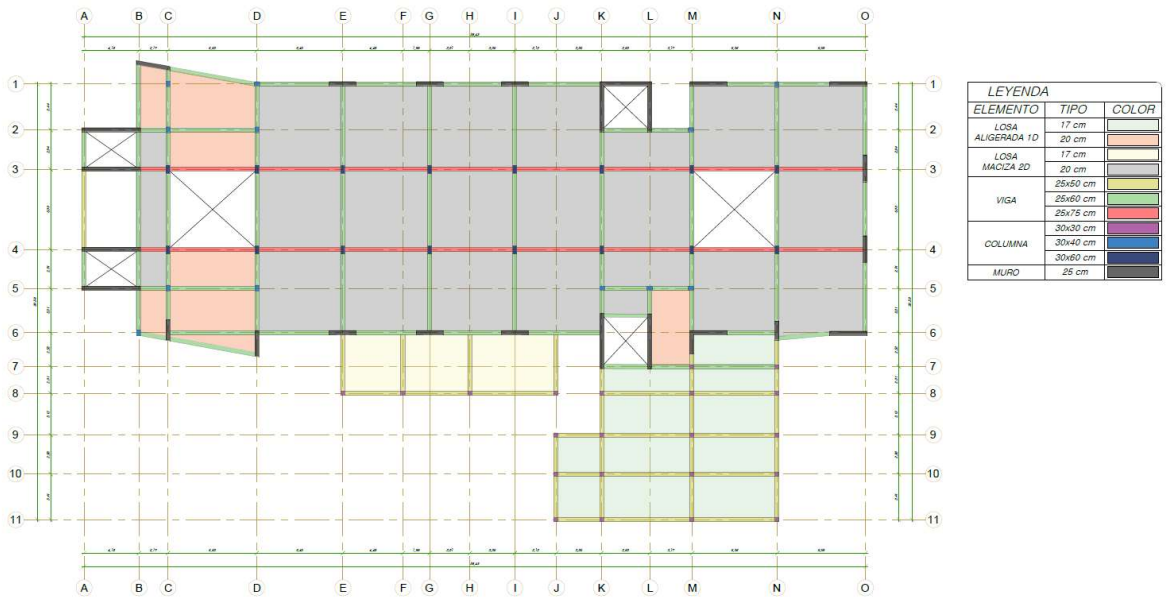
Predimensionamiento de planta del primer nivel. Fuente propia.
